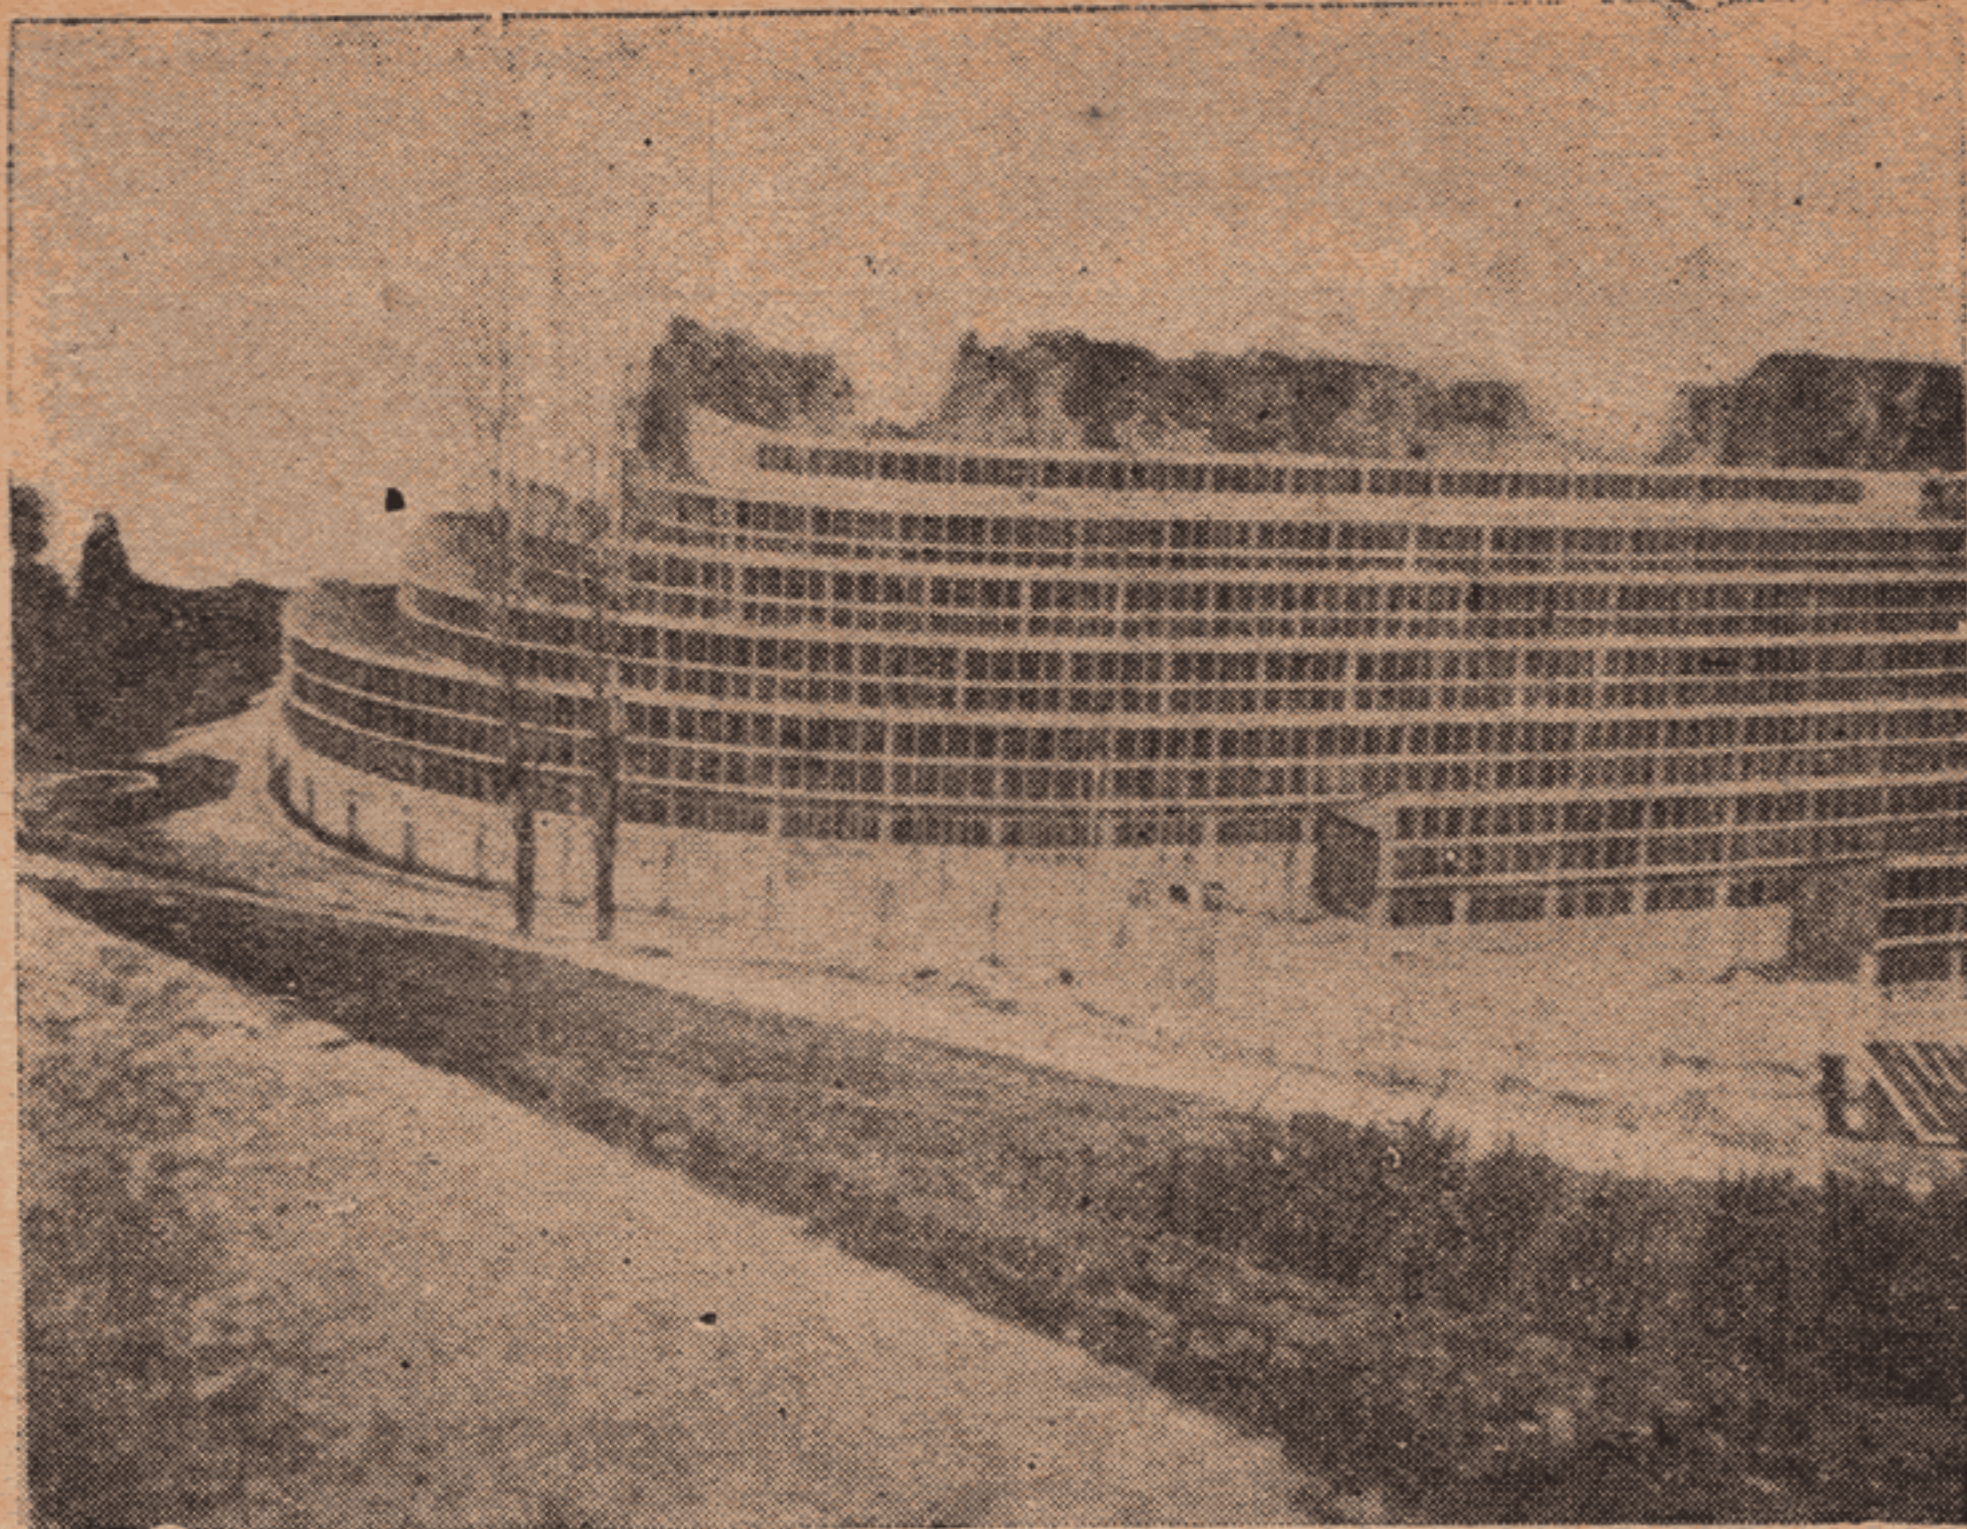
Лимонное перекрытие в Цихис-Дзири
